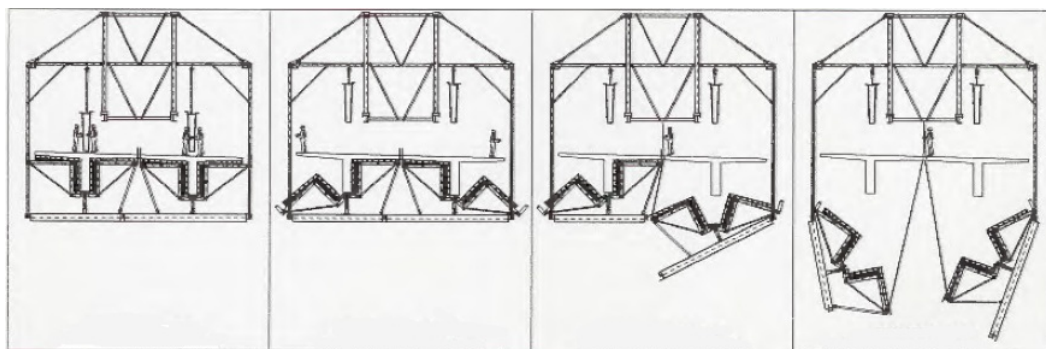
Secção transversal do cimbre autolanzável usado nos viadutos Tâmega 3 e Tâmega 4 [9].
